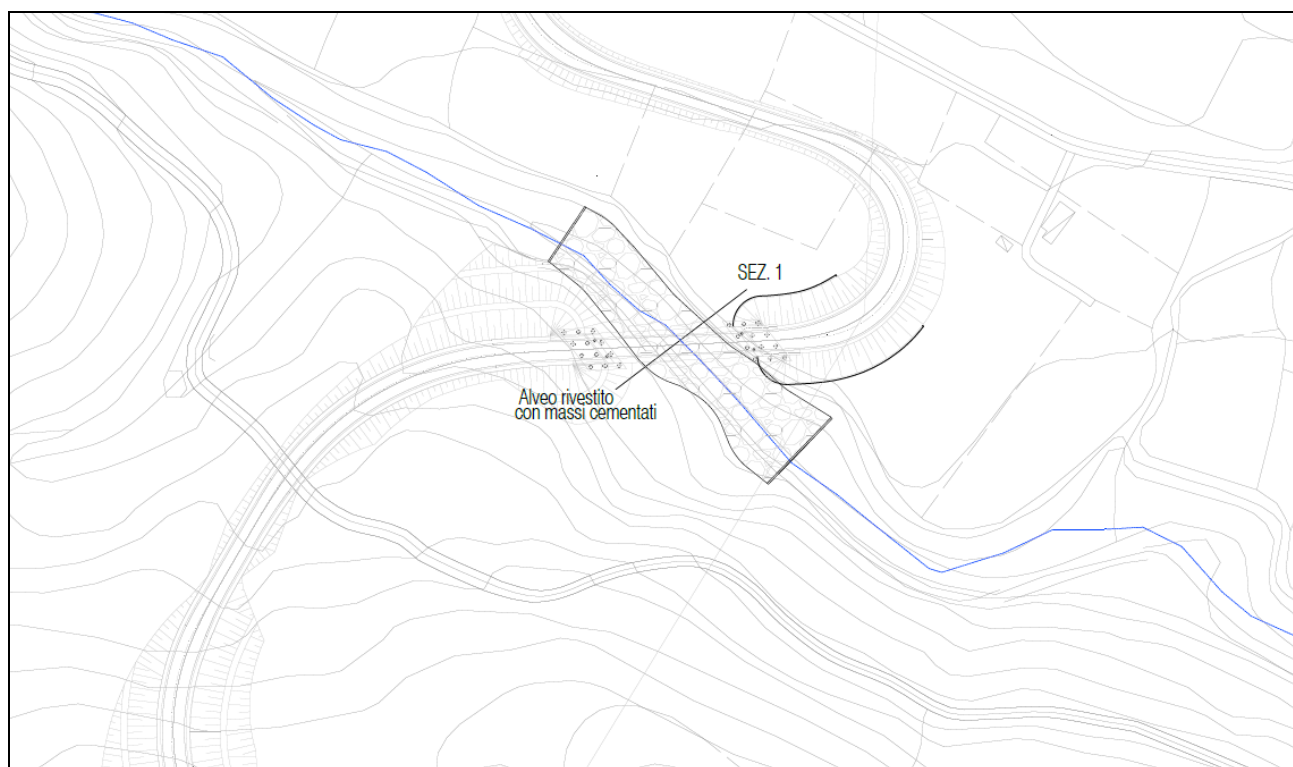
Pianta attraversamento stradale Rio Aiveglio
